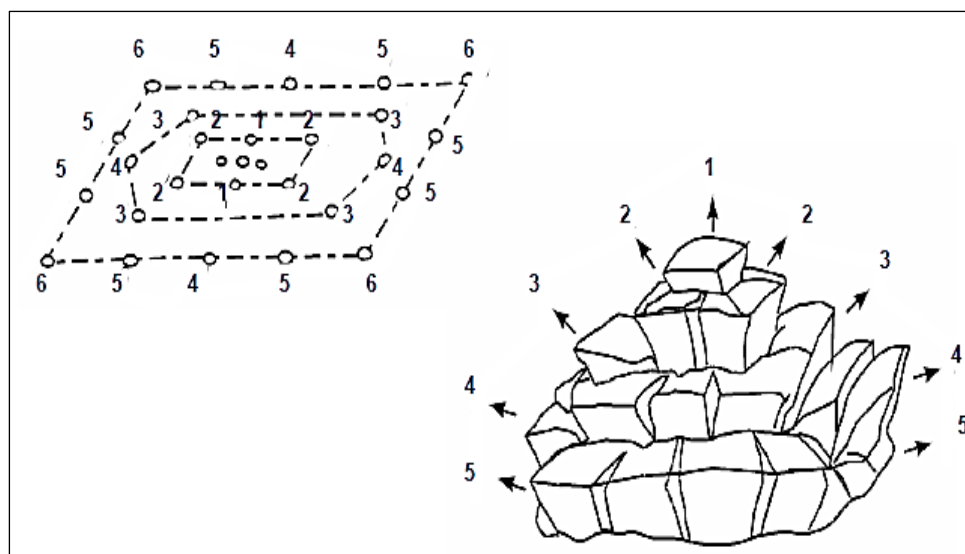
Secuencia de detonación transversal (perpendicular al eje de zanja)
